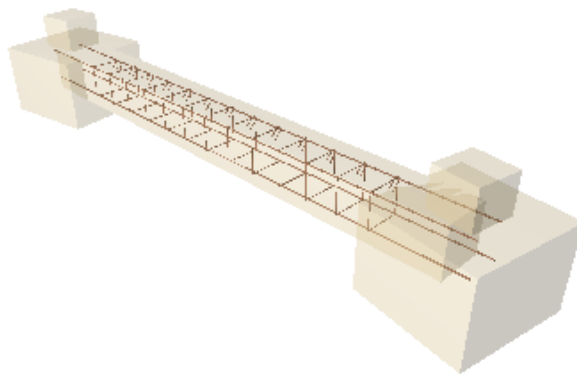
Viga atado zapata 3D estructura principal.
